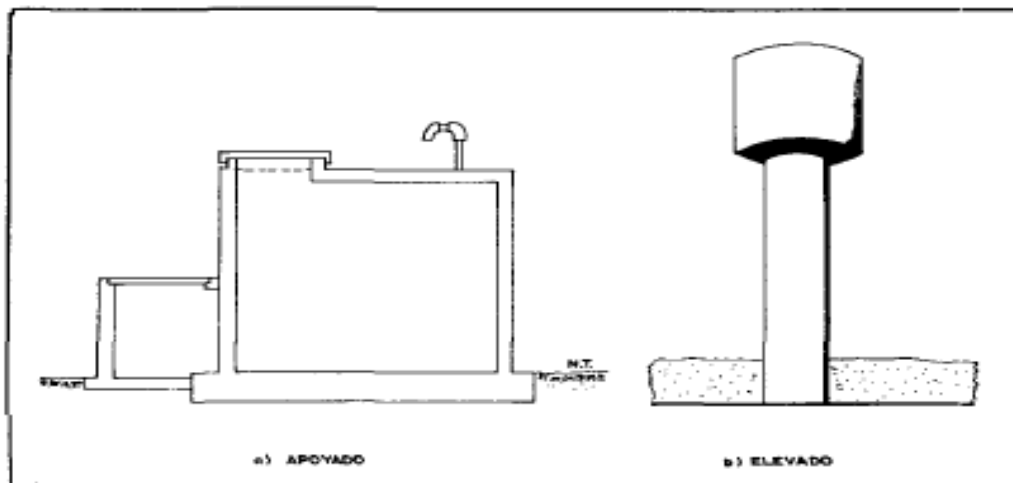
Tipos de reservorios: apoyado y elevado
